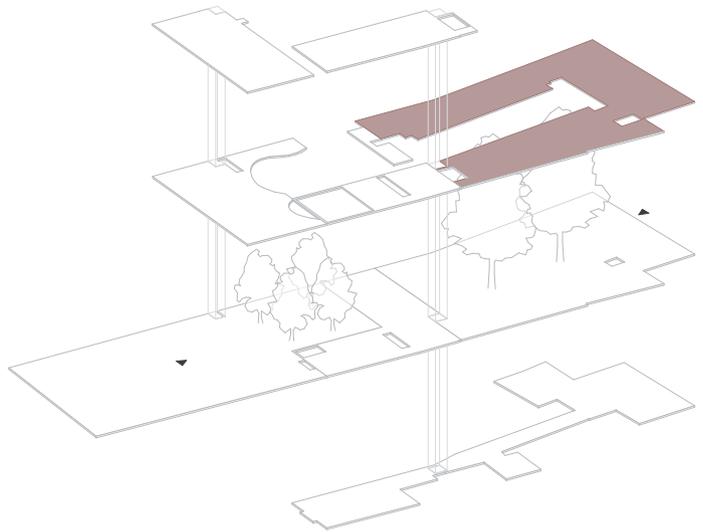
| Grundriss 1. Obergeschoß, Gemeinschaftsküche
